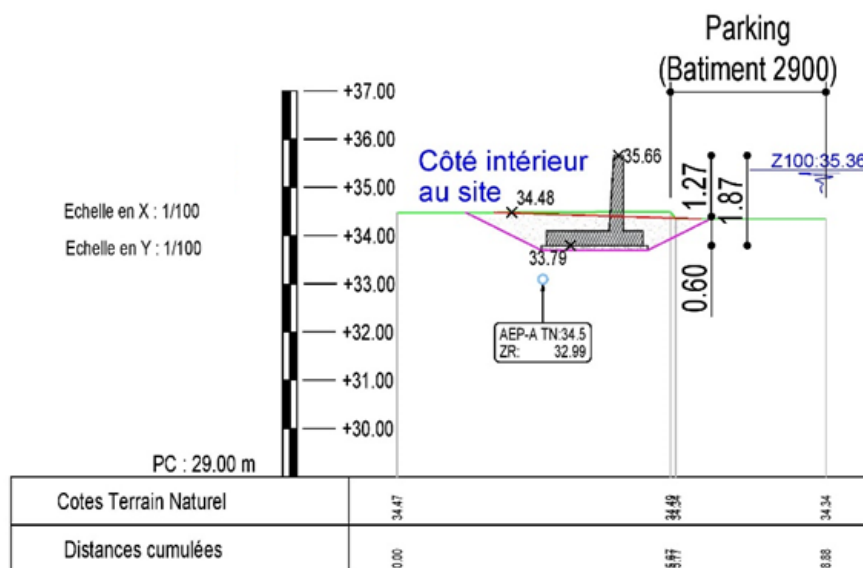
Profil en travers du mur 3 au PK 100.
